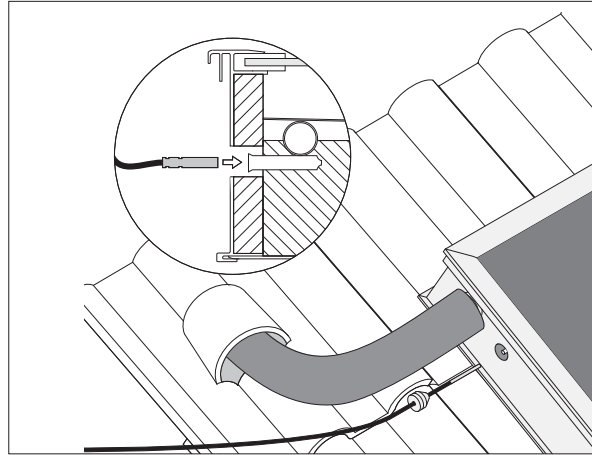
Fühler durch Gummistopfen ziehen und Fühlerspitze in Fühlerhülse stecken. Gummistopfen wieder eindrehen.
